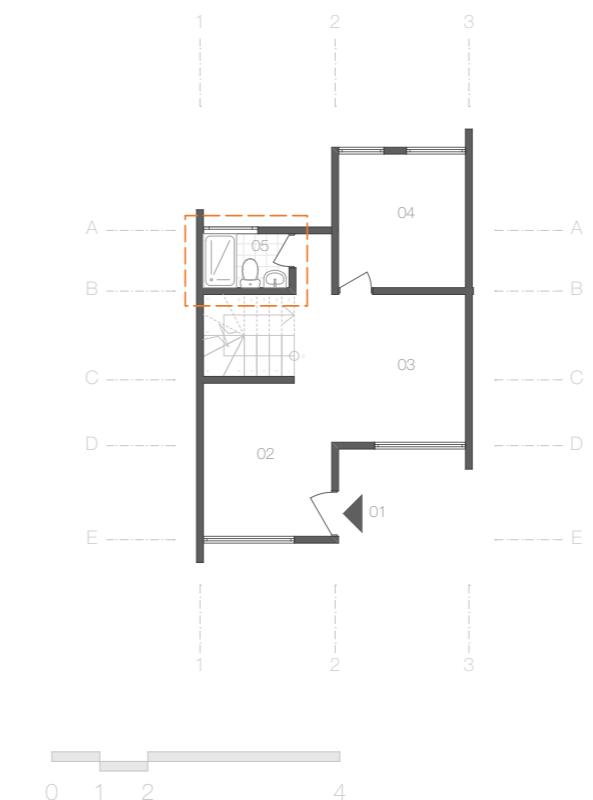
Conjunto Habitacional Tarqui Planta Baja
